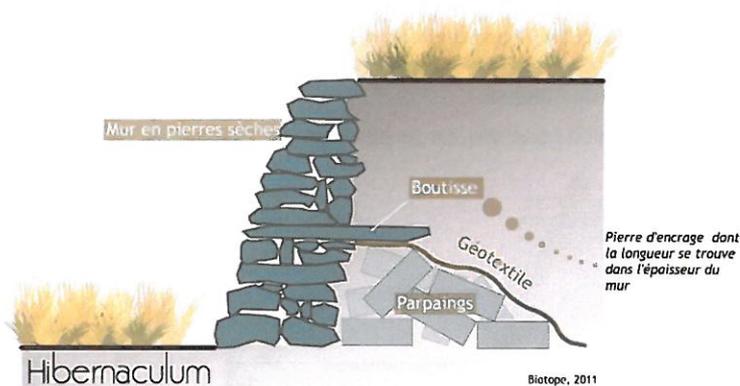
exemples d'éléments favorables au Lézard des murailles
